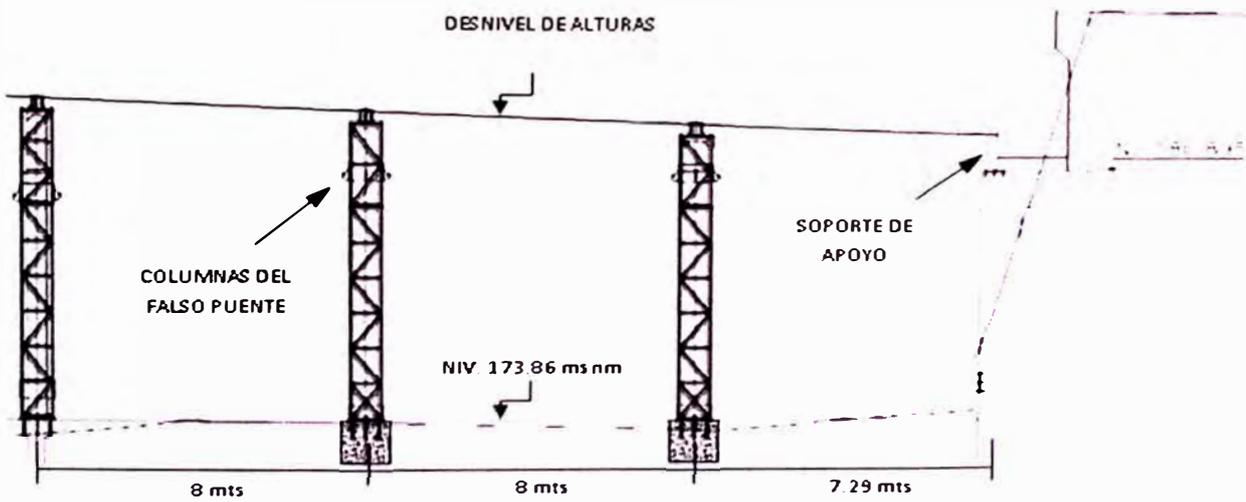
VISTA FRONTAL DEL MONTAJE DE COLUMNAS EN LOS
